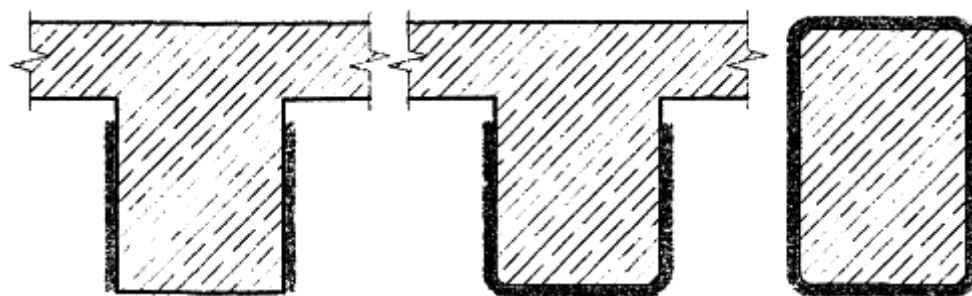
Схемы усиления сечений изгибаемых железобетонных элементов
